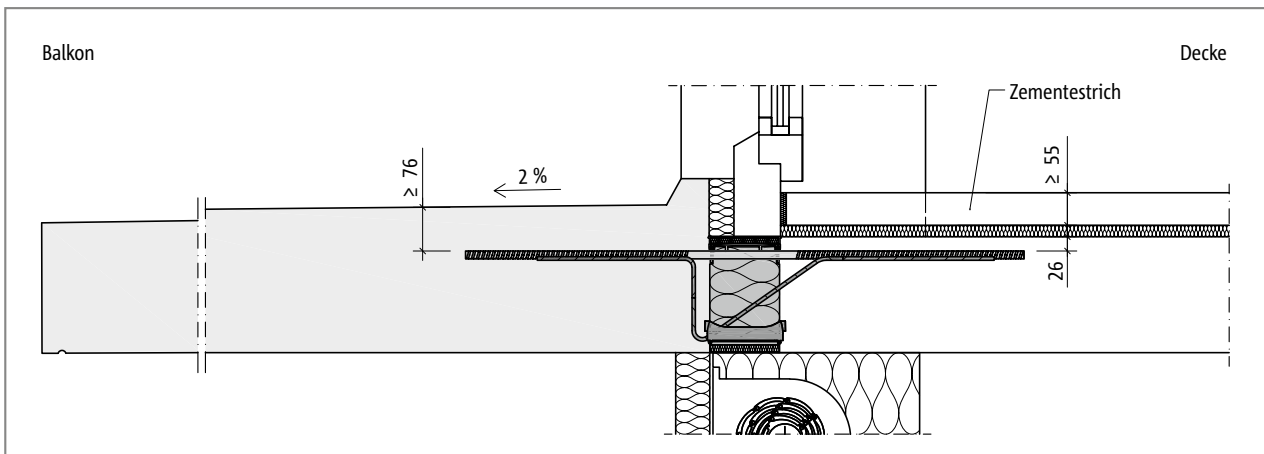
Schöck Isokorb® CXT Typ K-REI120: Fertigteil mit höherer Betondeckung und Bodenbelag innen für Brandschutzklasse REI120
